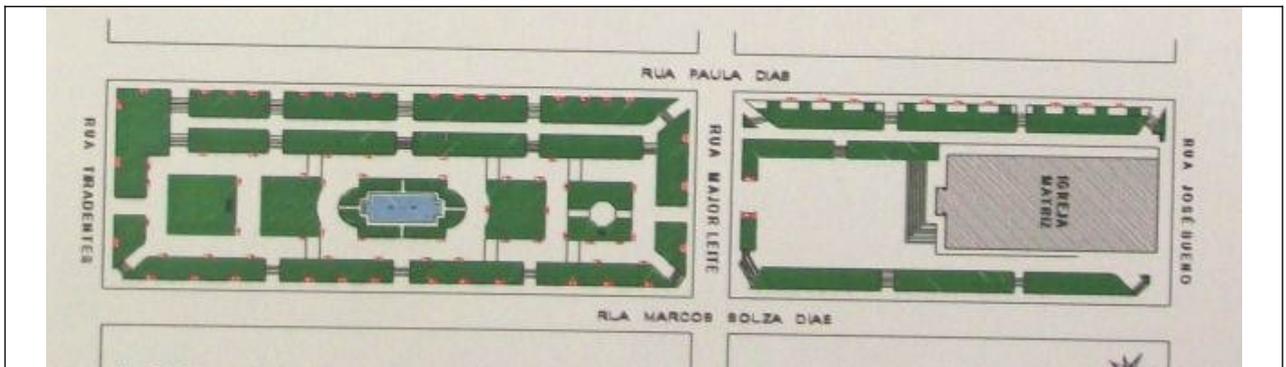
Planta da Praça Oswaldo Costa em sua totalidade – atual configuração.
